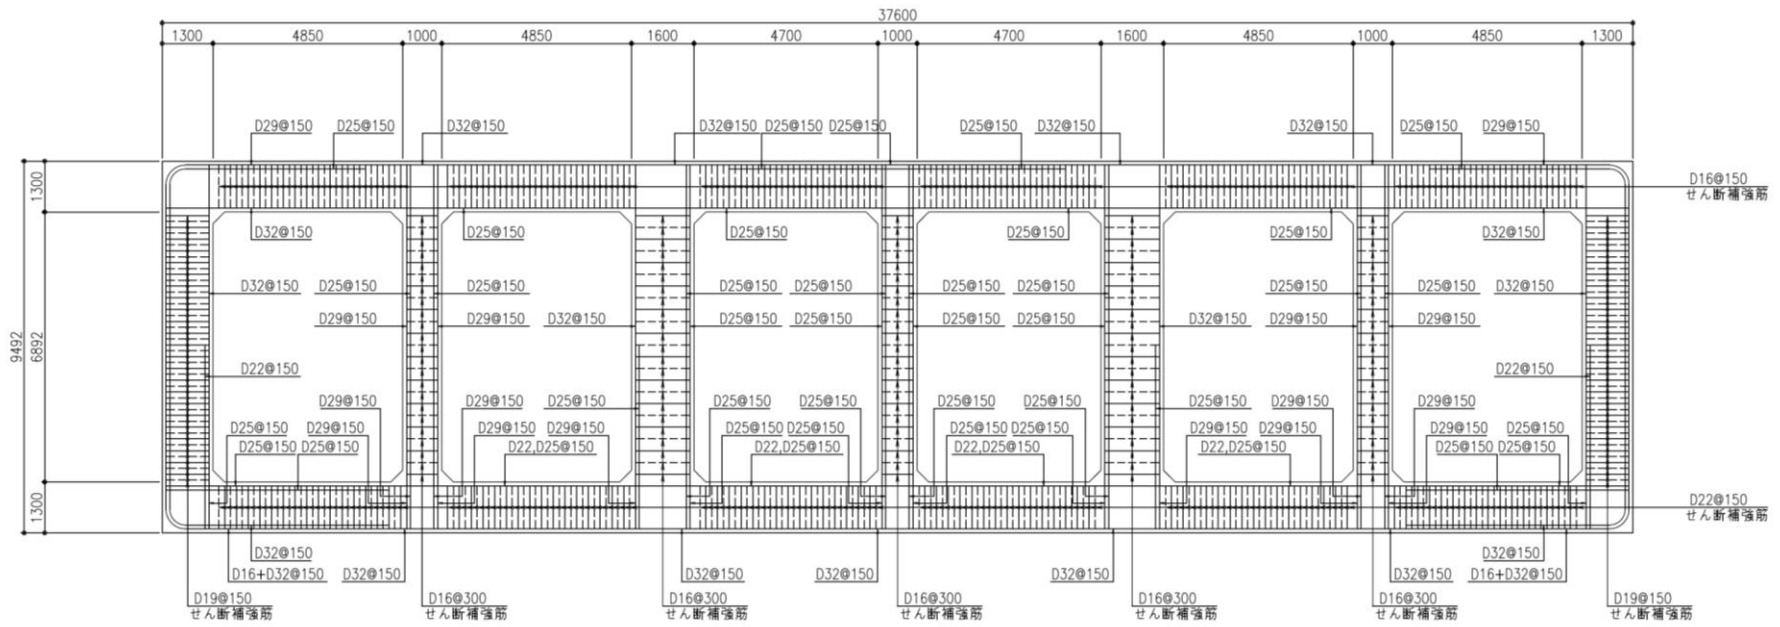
取水路の配筋図 (漸拡部, C-C断面)
